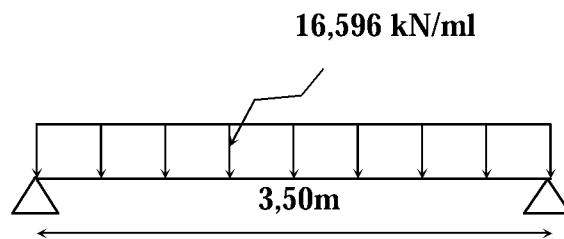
Schéma statique de la poutre de chaînage à l'ELU.
